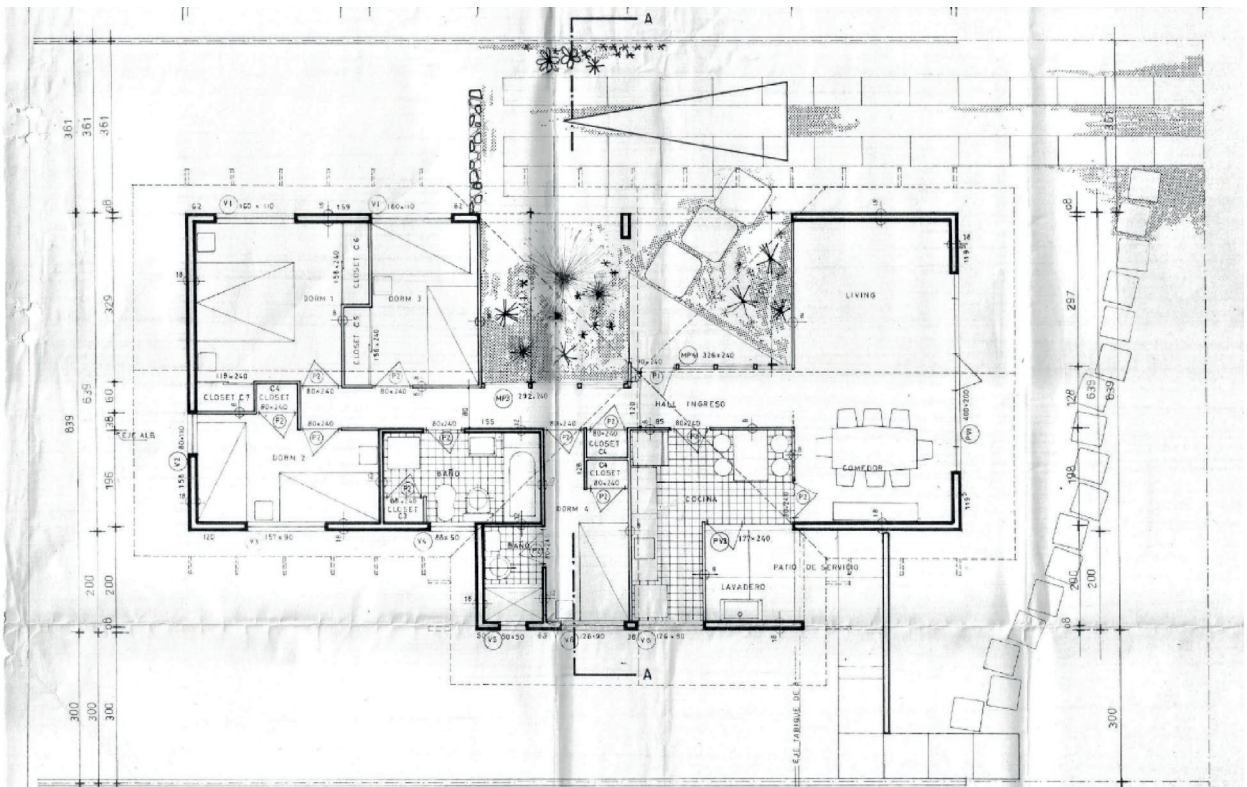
Planta tipo A. Fuente: Archivos DOM (1969).
